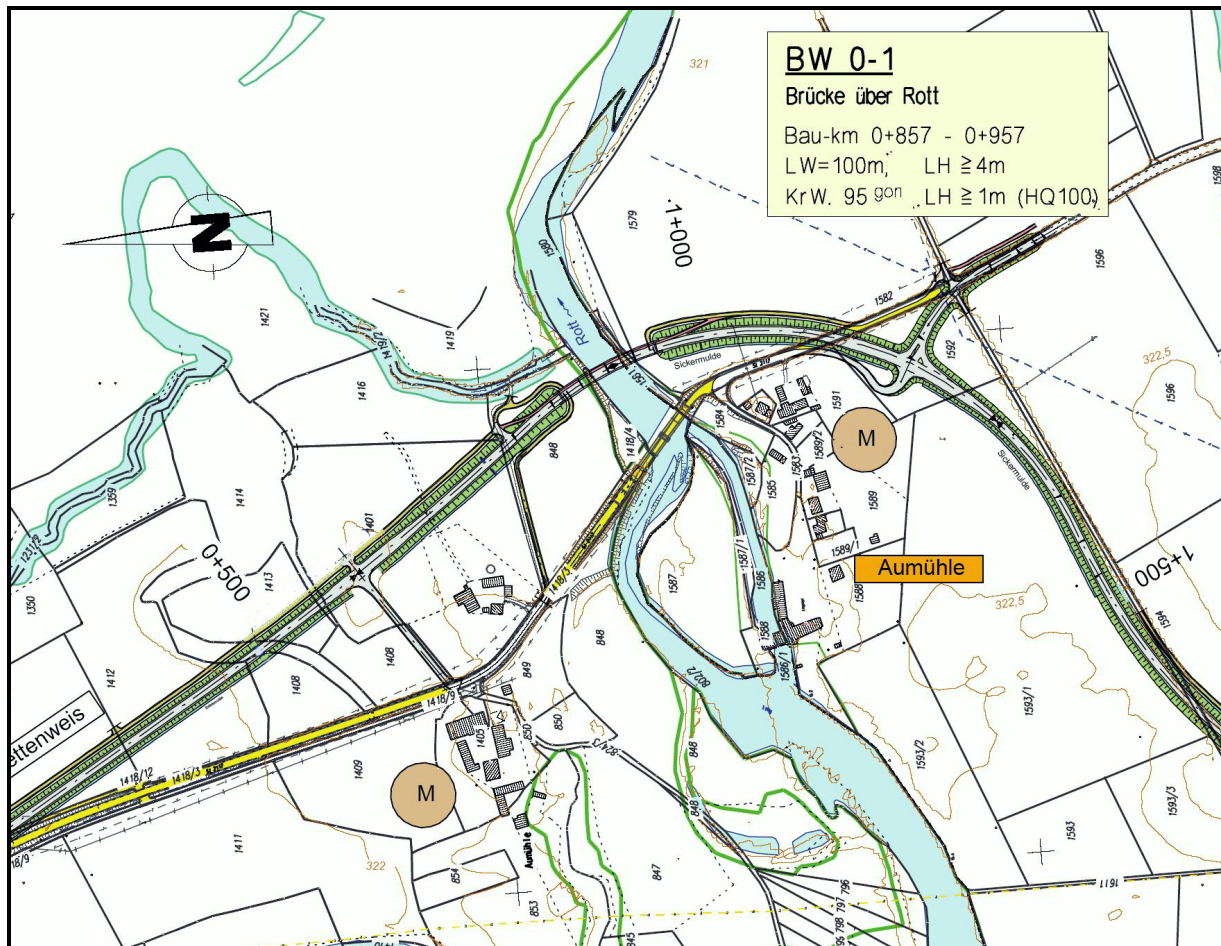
Lageplan der neuen St 2117 mit Rottbrücke, Rückbau ist gelb markiert
